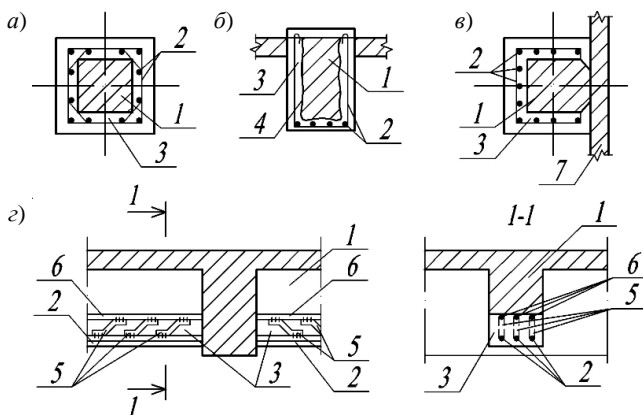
Схемы усиления железобетонных конструкций увеличением сечений:
